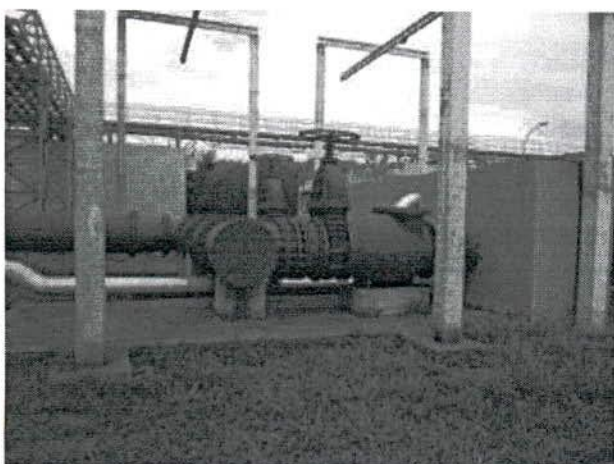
ETE Ipanema – Estação Elevatória de Esgoto
